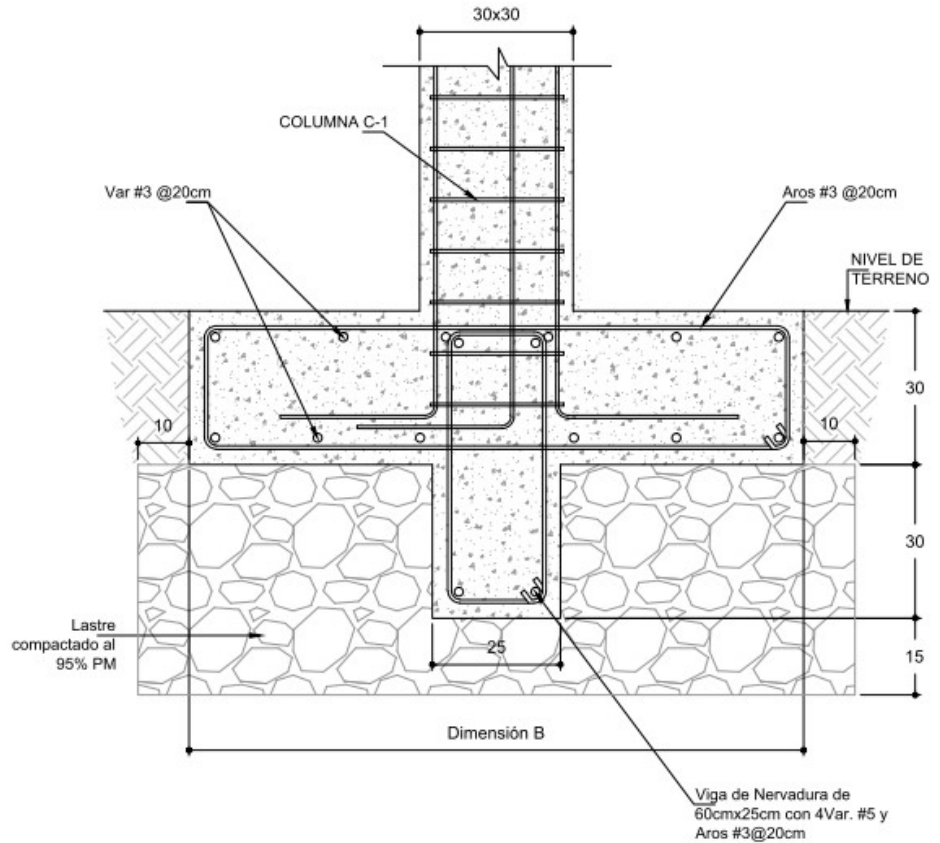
Planta estructural de cimentaciones - Martínez, 2019.
